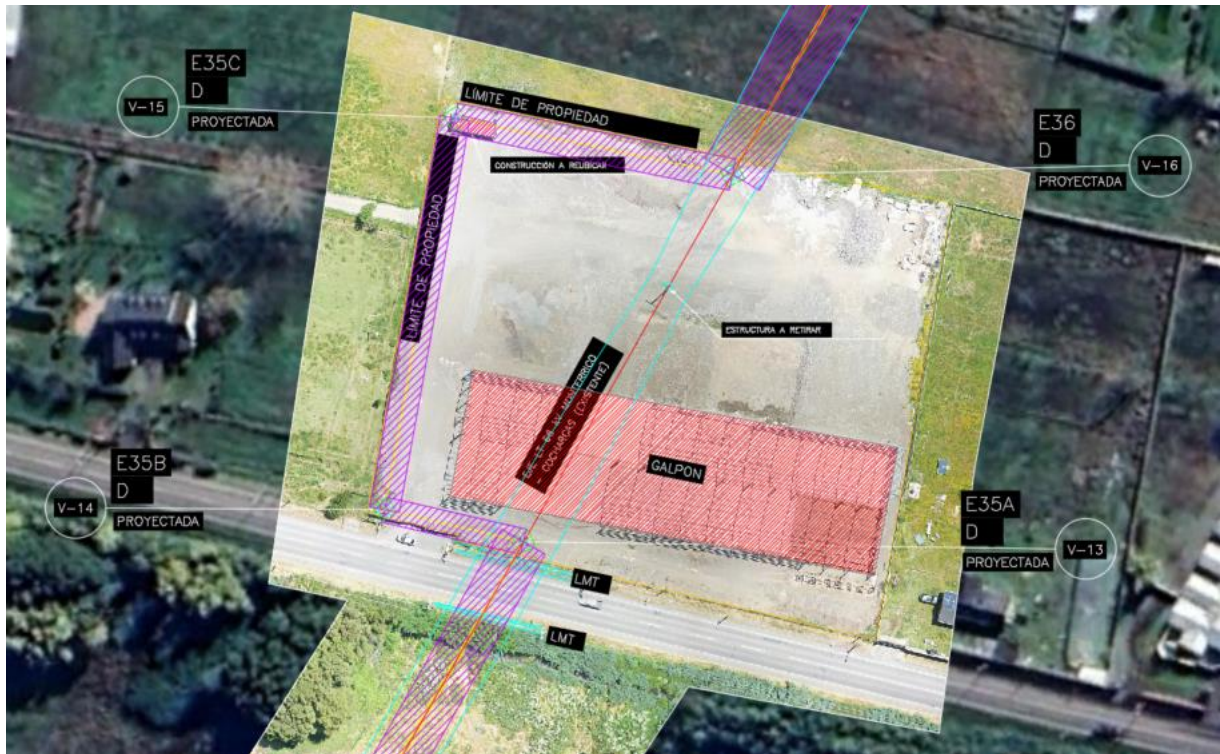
Tramo entre E35 – E37 (proyectado)
